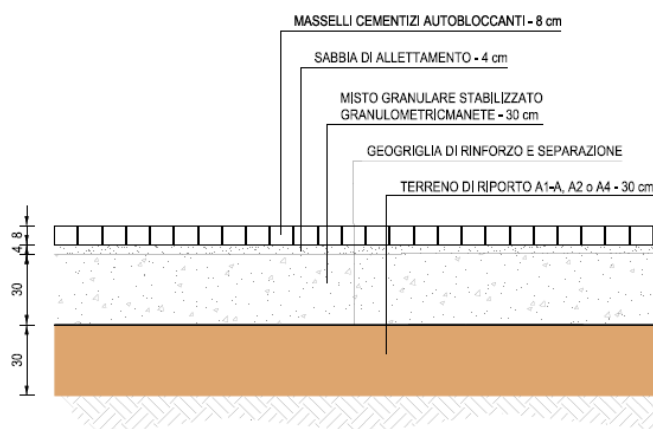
Stratigrafia di progetto Viale delle Rimembranze
